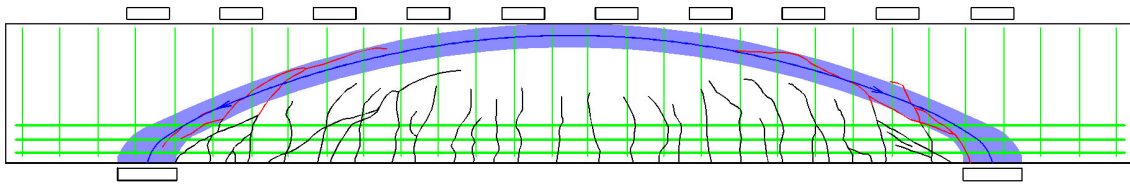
Balken C 2 mit überlagerter Druckparabel und zugehörigen Rissen
